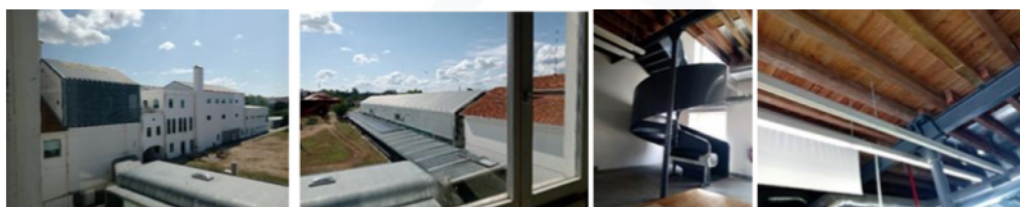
O complexo após as obras. Fachadas em alvenaria caiada, a cobertura metálica sobre os trilhos da estrada de ferro, a escada metálica em caracol, lembrando as escorregadoras de sacas e os madeiramentos e suportes metálicos aparentes nos telhados. Fonte: fotos de Evelyn Lima, 2022.
